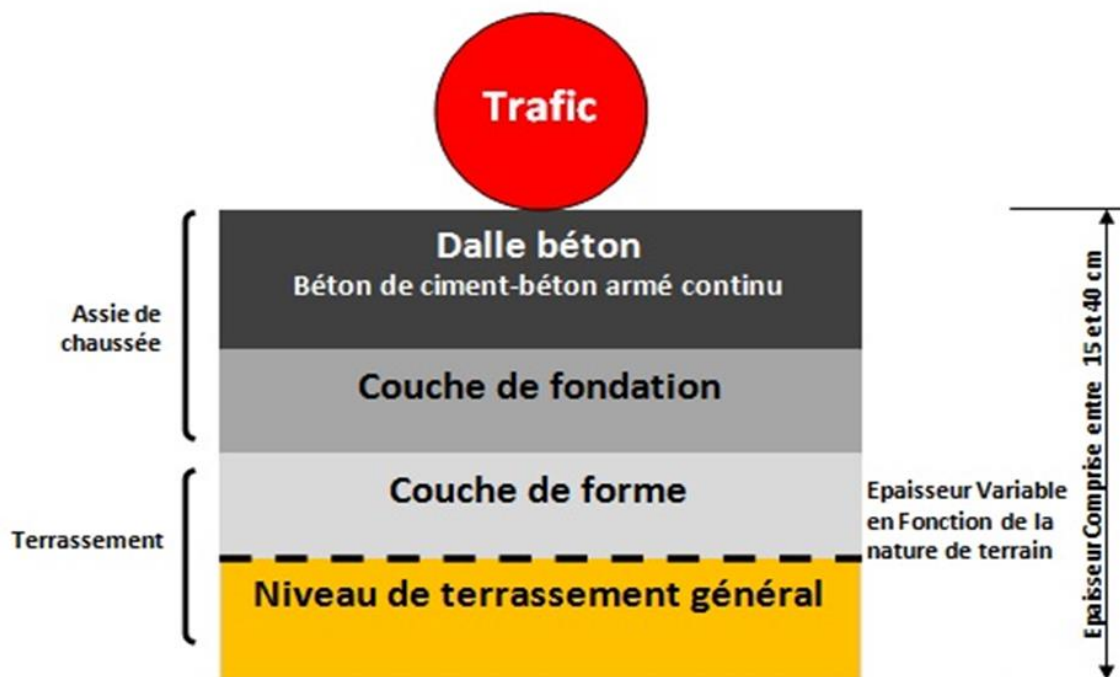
Structure type d'une chaussée rigides (ou en béton de ciment)
